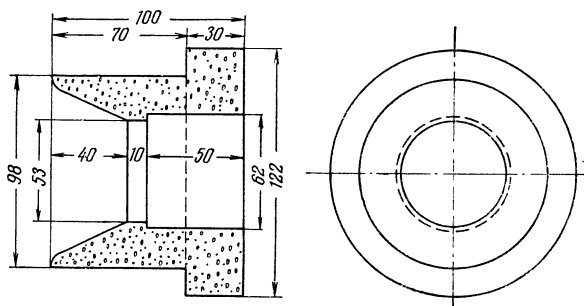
Бетонная или деревянная переходная пробка для вывода кабеля из подземного трубопровода
